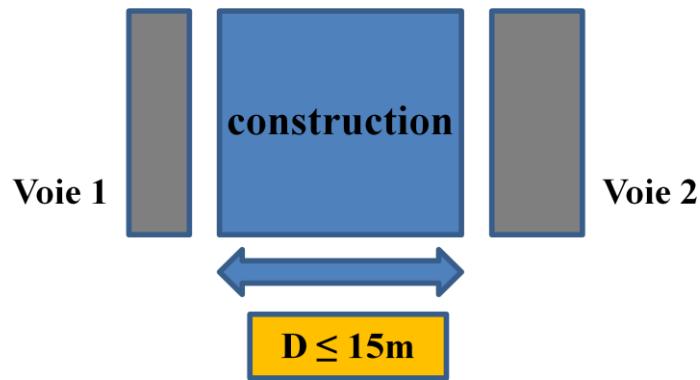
La hauteur d'un bâtiment construit entre deux voies d'inégales largeurs ou de niveaux différents
